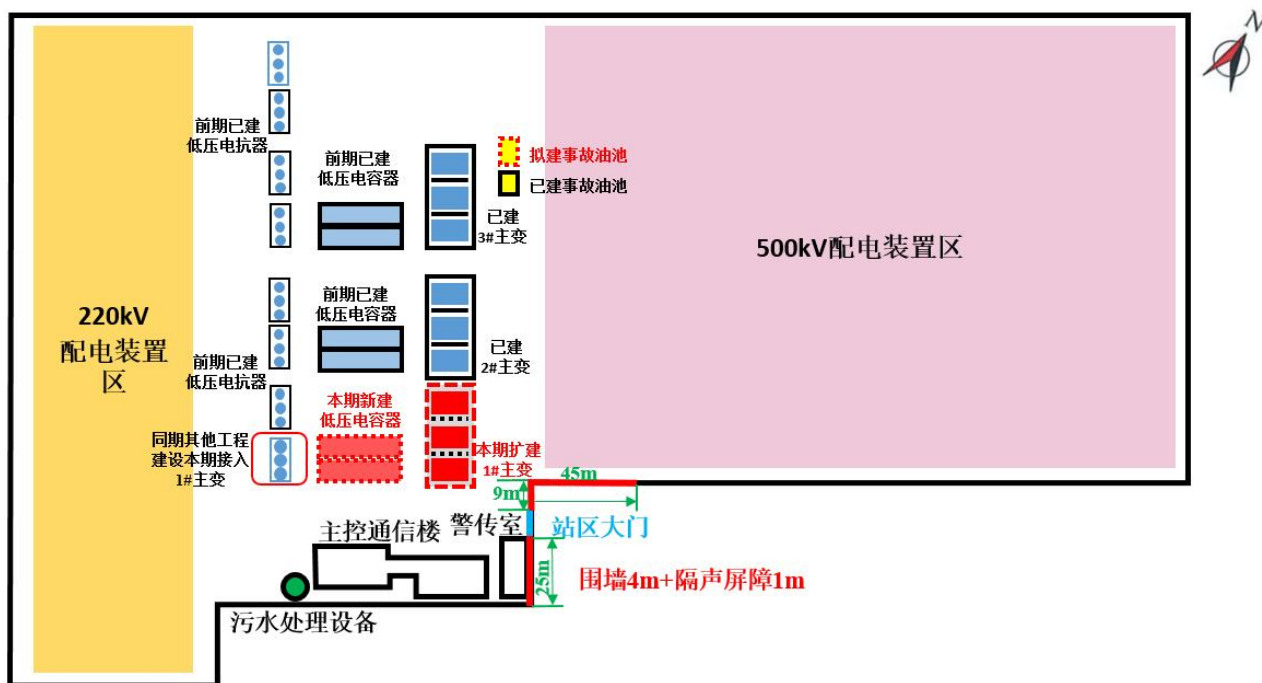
500kV 圭峰变电站总平面布置和隔声屏障布置示意图
